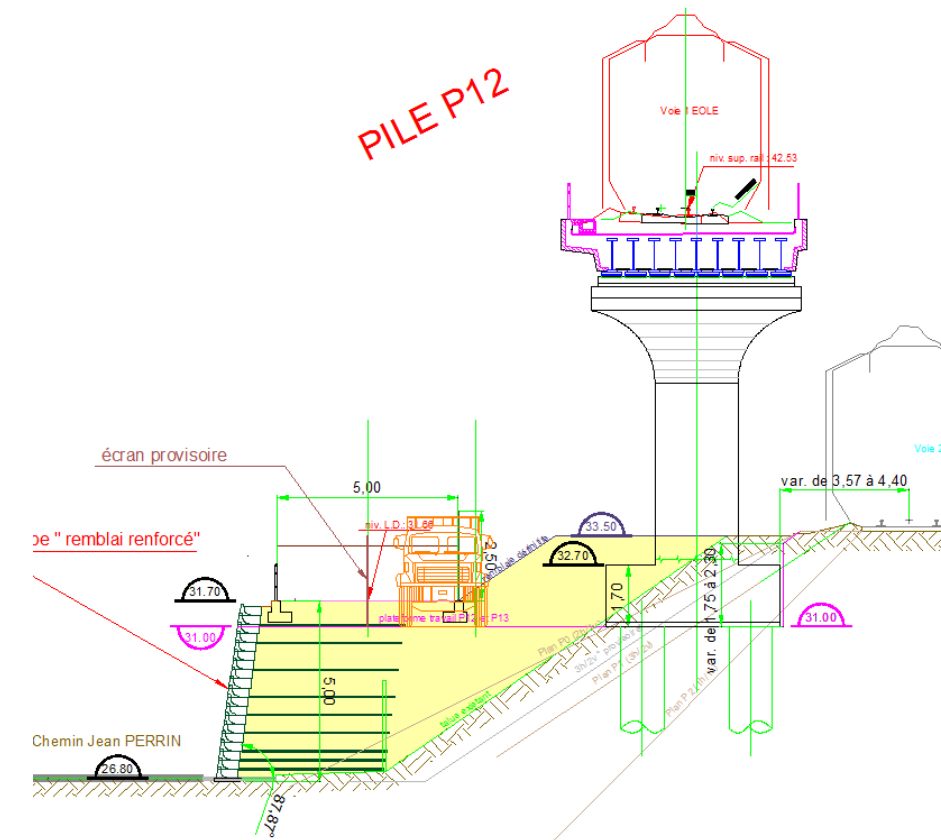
Coupe schématique de l'ouvrage de transition (avec rampe liaison douce représentée en jaune)
